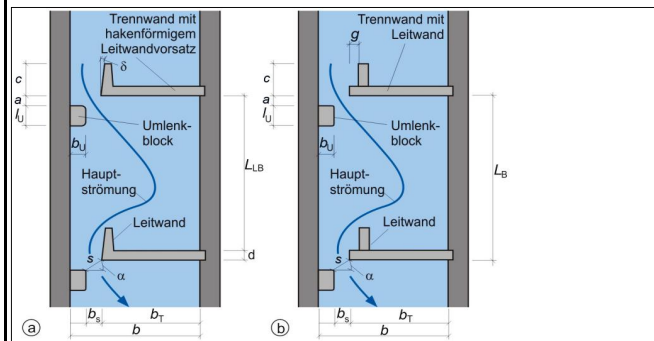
Abmessungen und Bezeichnungen beim Schlitzpass mit einem Schlitz (Grundriss): a) hakenförmiger Leitwandvorsatz; b) vereinfachte Leitwand (Grafik: KRÜGER)
